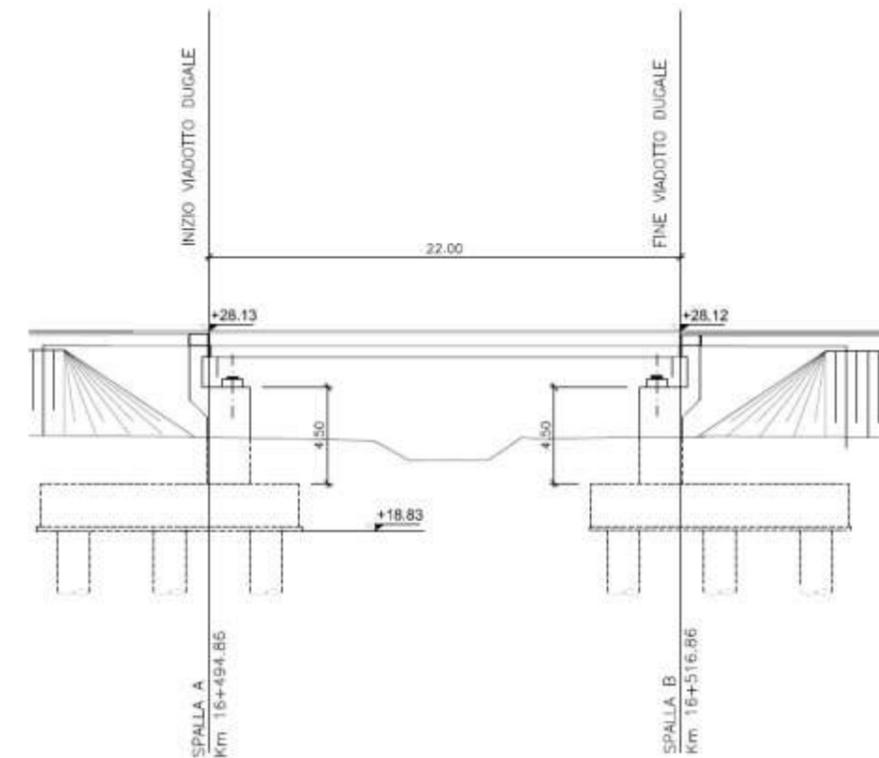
Sezione longitudinale ponte "Dugale 2".
